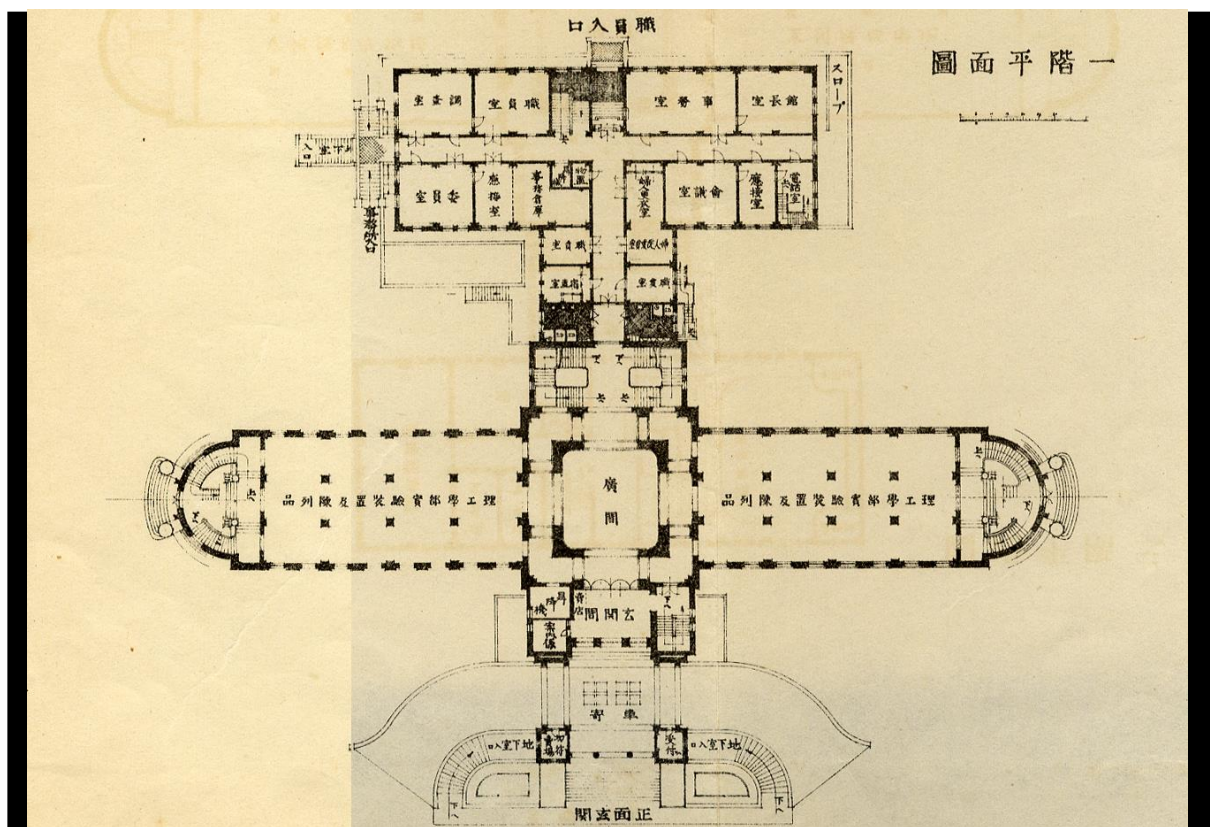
東京博物館復興建築設計圖（部分 1 階平面圖）
